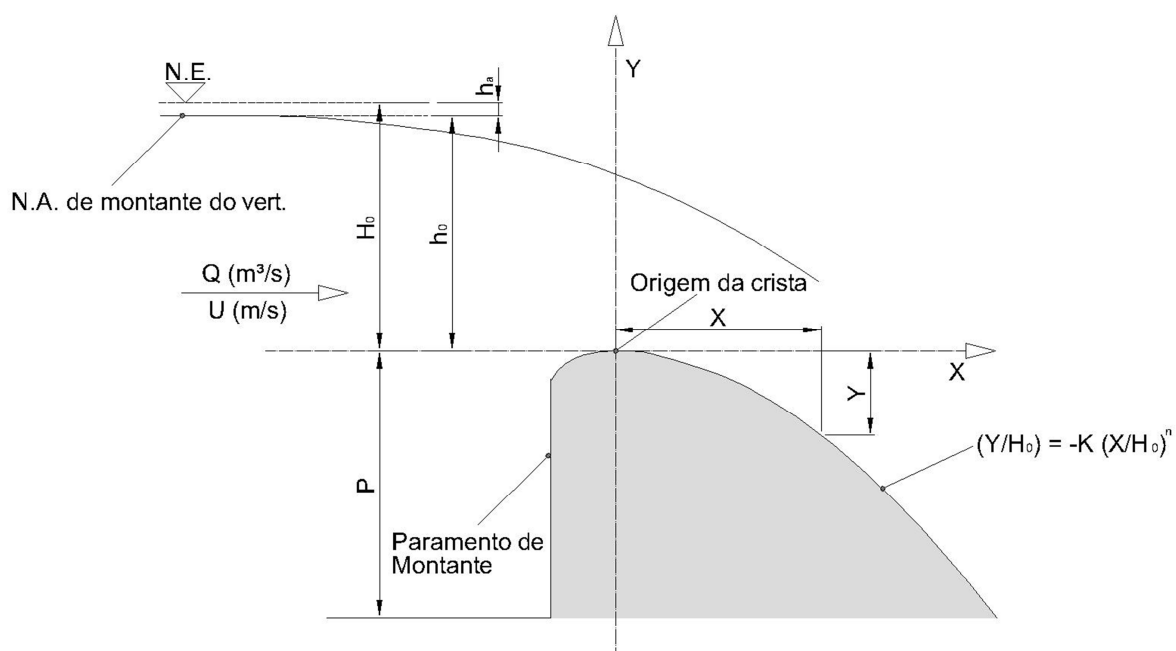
Elementos de um perfil de vertedouro tipo Creager – adaptado de USBR (1987)
